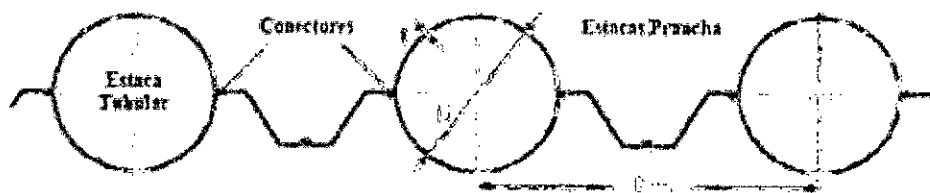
Esquemático Típico da Construção do Barramento Metálico
